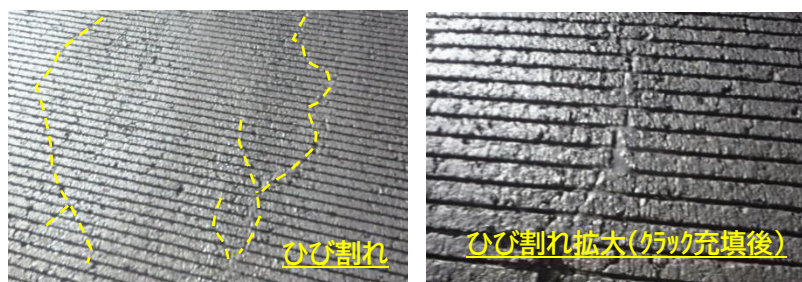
改修前の損傷状況 (B 滑走路, 路面ひび割れの様子)
